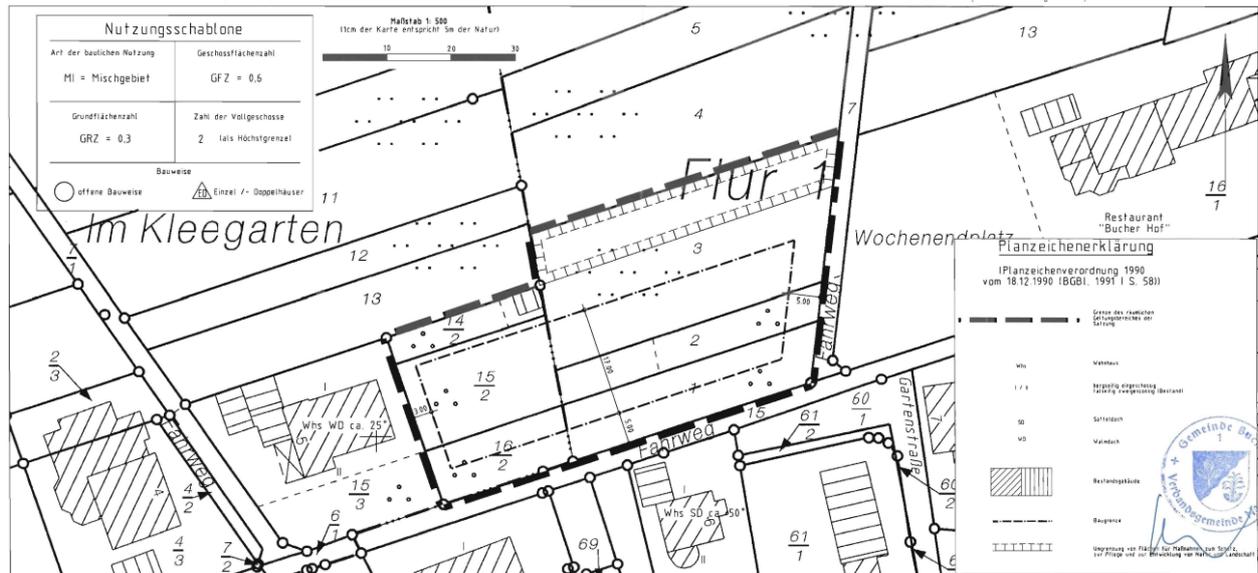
Bebauungsplan „Ergänzungssatzung Nr. 2 der Ortsgemeinde Buch“
